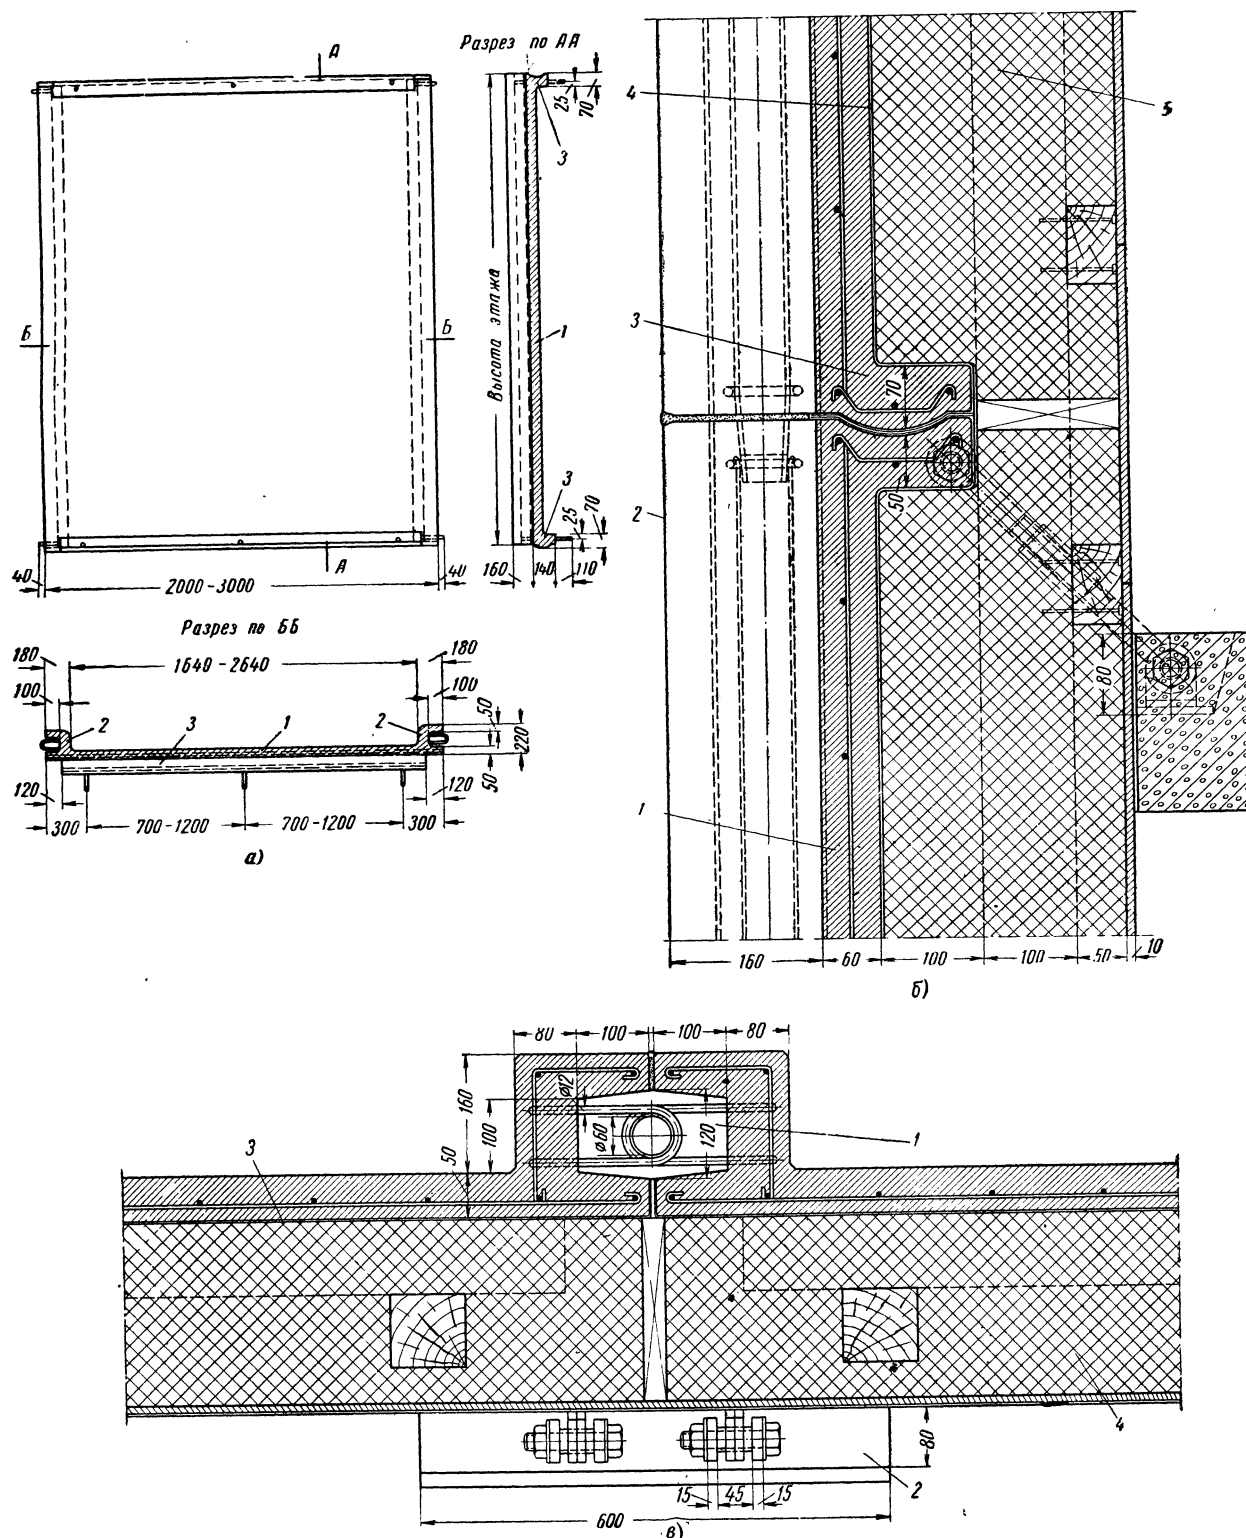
а) эскиз железобетонной плиты стеновой панели:
